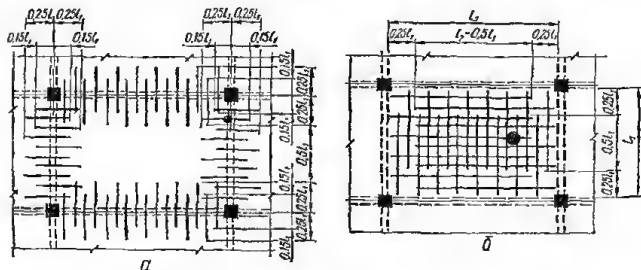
Схема армирования плиты, опёртой по контуру:
